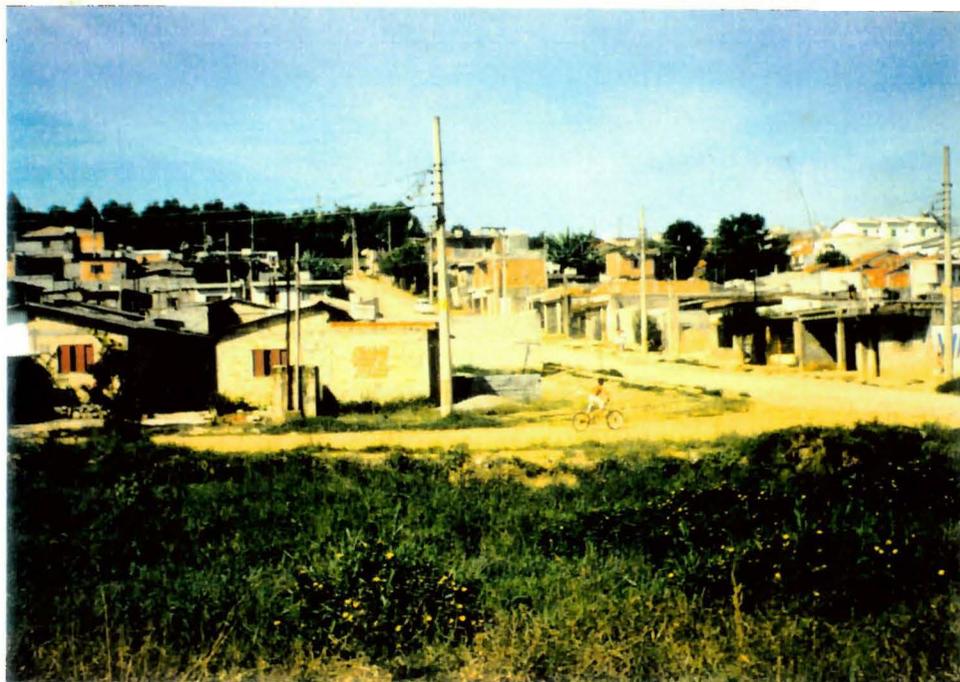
Jardim Néia. Casas autoconstruídas na gestão Mário Covas. Vista geral (foto de 1993).
